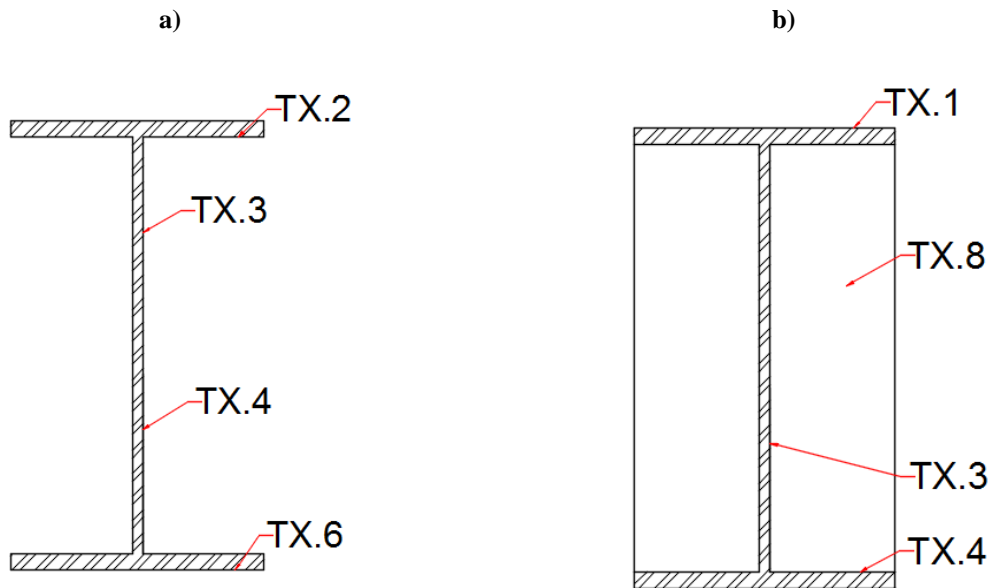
Instrumentação do ensaio experimental a) Viga puramente metálica; b) viga mista de aço e concreto parcialmente revestido
